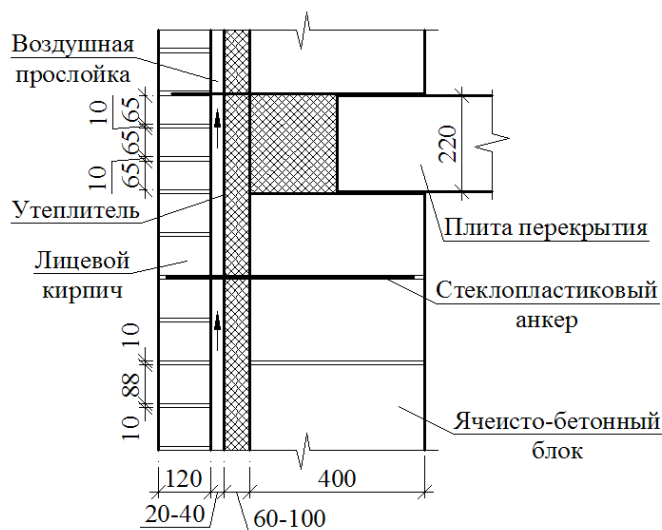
Узел многослойной стены с воздушной прослойкой из легкобетонных блоков
